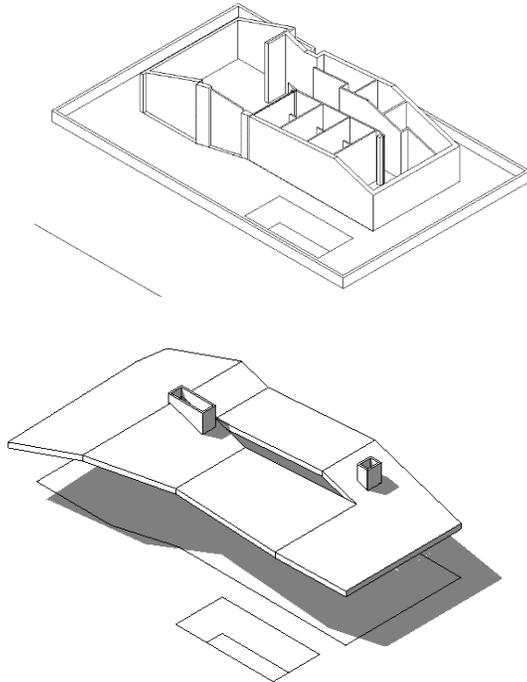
Elaboración de muros y cubierta en LOD 100.
